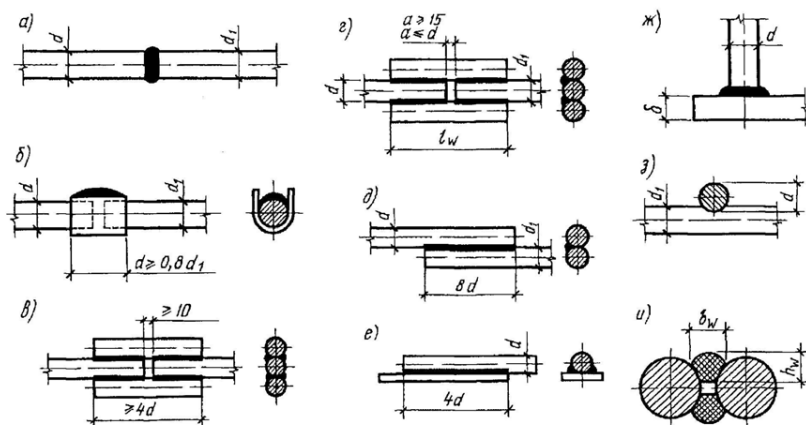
Стыки ненапрягаемой арматуры сваркой: а – контактной; б – ванной в инвентарной форме; в, г – электродуговой с накладками; д – электродуговой внахлестку; е – электродуговой с пластиной; ж – электродуговой перпендикулярно к пластине; з – контактной сваркой пересекающихся стержней; и – высота и ширина сварного шва
